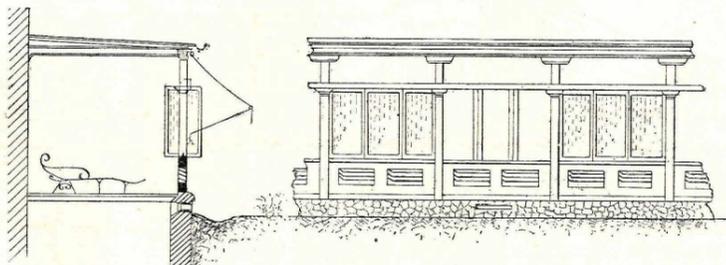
Sezione trasversale e prospetto della veranda del Sanatorio di Heiligenschwendli.
